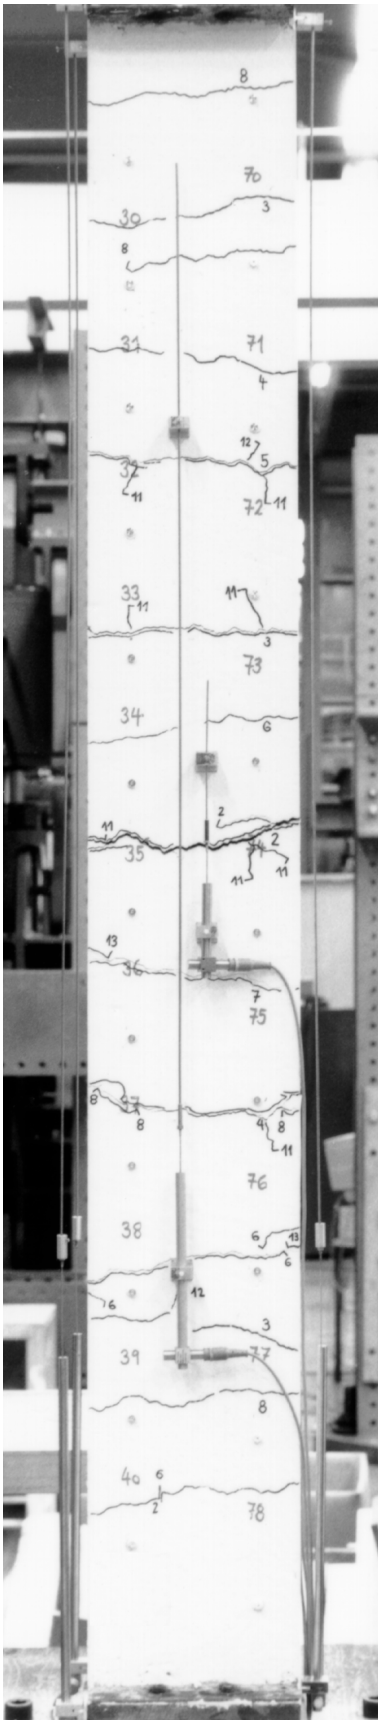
T100.30: Rissbild bei Laststufe 13.
